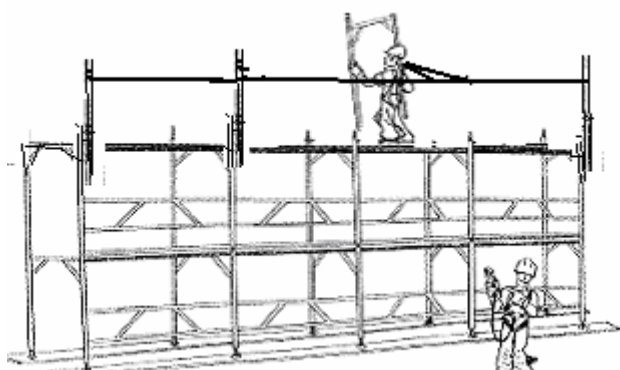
Montaggio/smontaggio con l’operatore collegato con due cordini alla linea di ancoraggio
